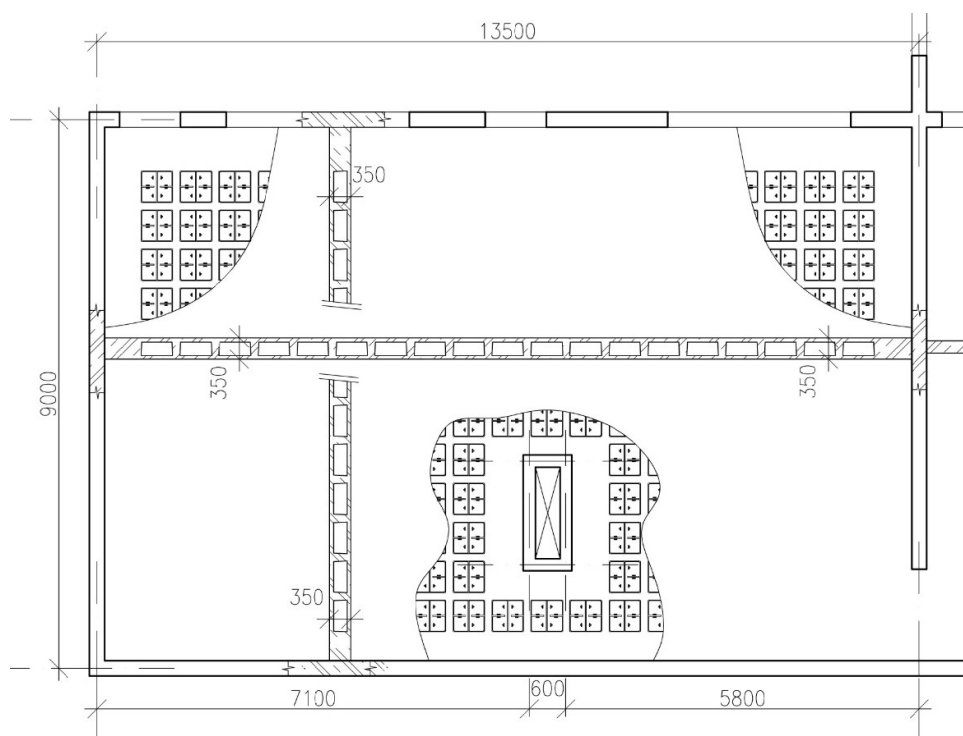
Schémata konstrukčního systému typického a 6NP
